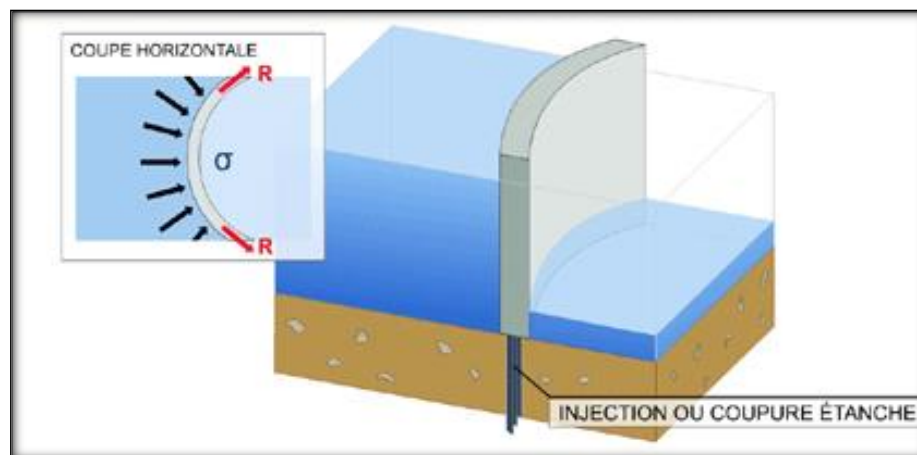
Barrages en béton- type voûte (Procèdes généraux de construction des barrages)
